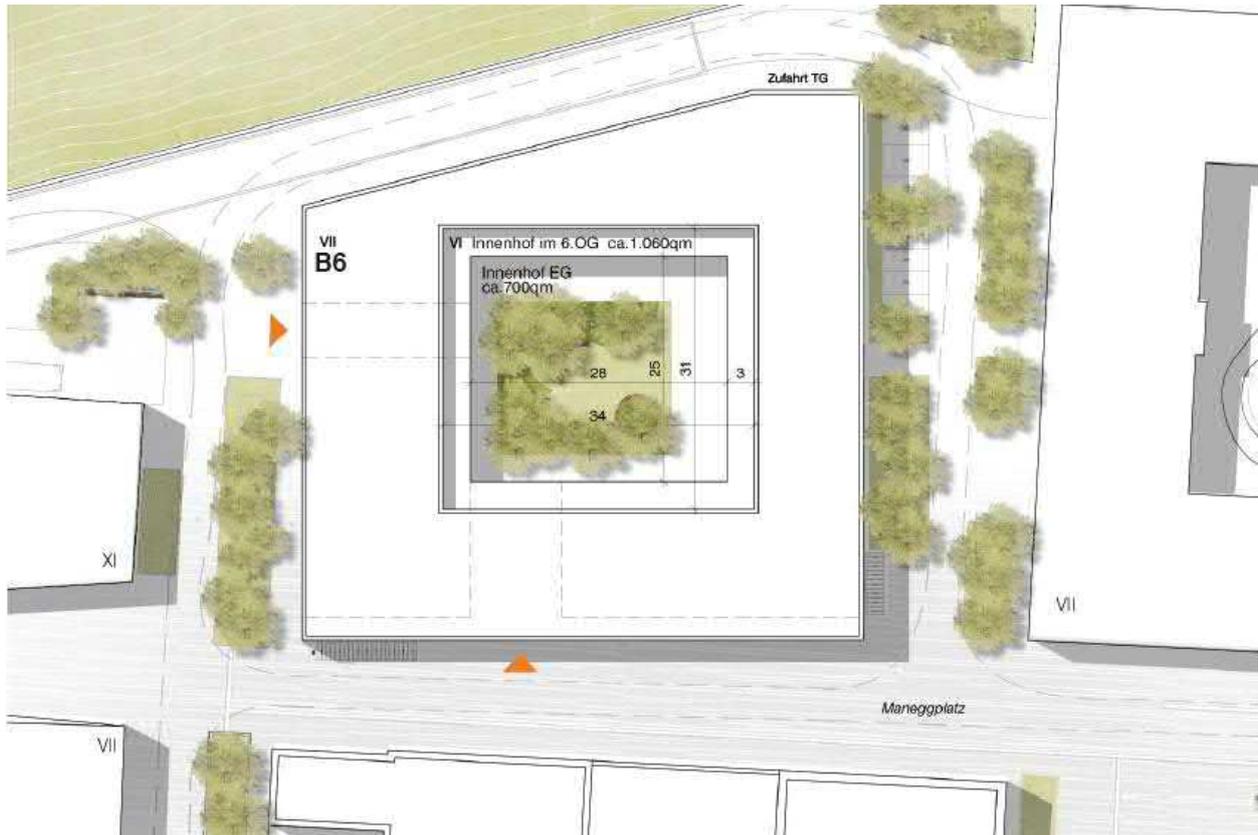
Schematische Darstellung Innenhof B6 bei Alterswohnen/-pflege, Gewerbe und Dienstleistung (Quelle: JSWD Architekten, Vogt Landschaftsarchitekten 2020)
